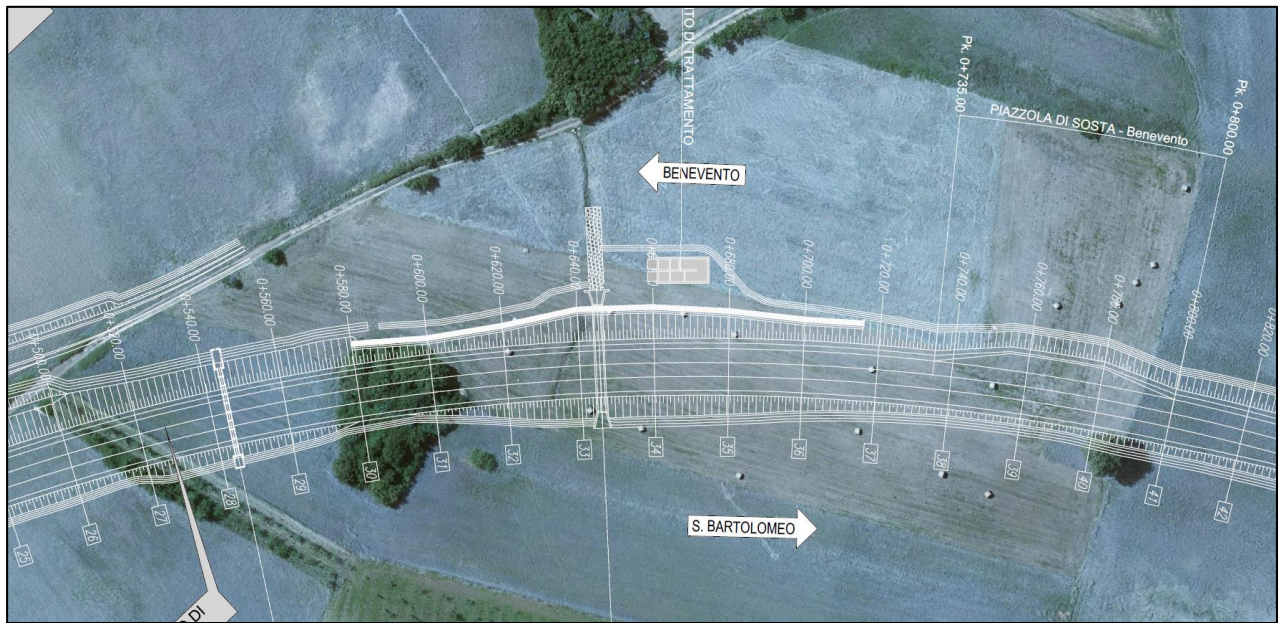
Planimetria su ortofoto dell'area della paratia
